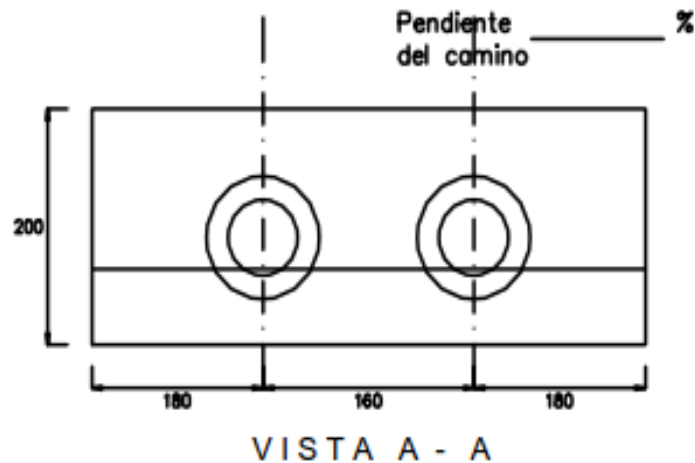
Vista en corte horizontal de las obras de drenaje dos líneas de tubería de concreto.
